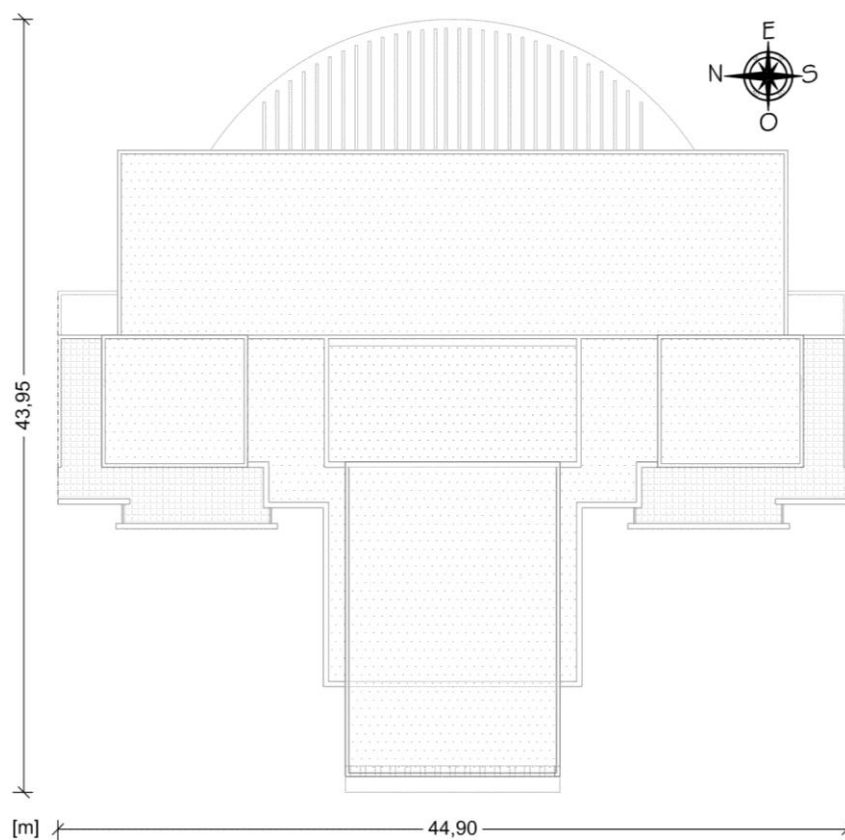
Planta Arquitetónica do Piso 3 e 4 (coberturas planas): corpo E (s/escala).
